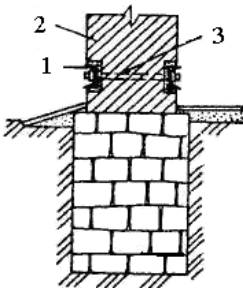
Повне розвантаження фундаменту поздовжніми балками:
